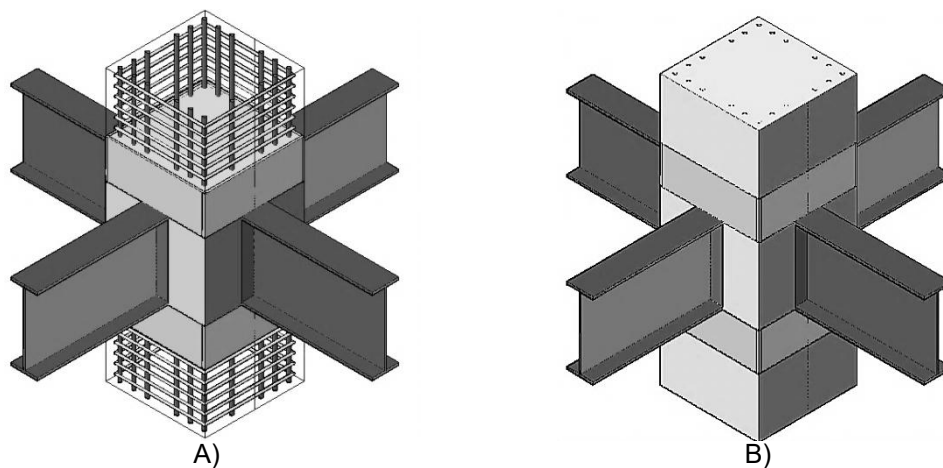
Esquema tridimensional de la conexión A) conexión con concreto después de las placas de banda B) conexión completa
